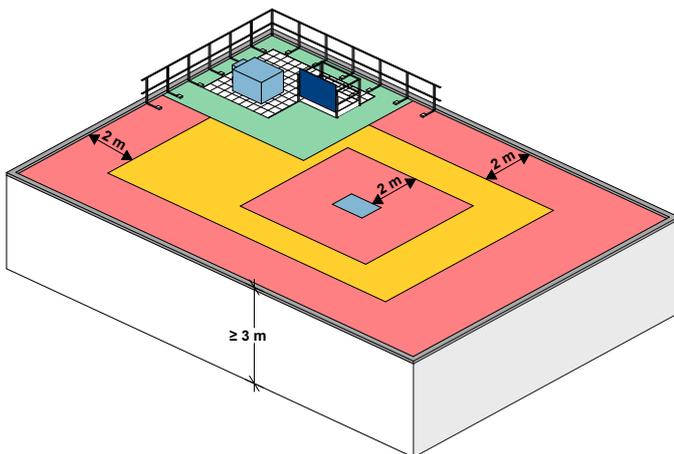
(Verde) Area sicura non pubblica, (Giallo) Zona pericolosa interna, (Rosso) Zona pericolosa con alto rischio di caduta, (Blu) Elemento di luce diurna non a prova di sfondamento o apertura del tetto
